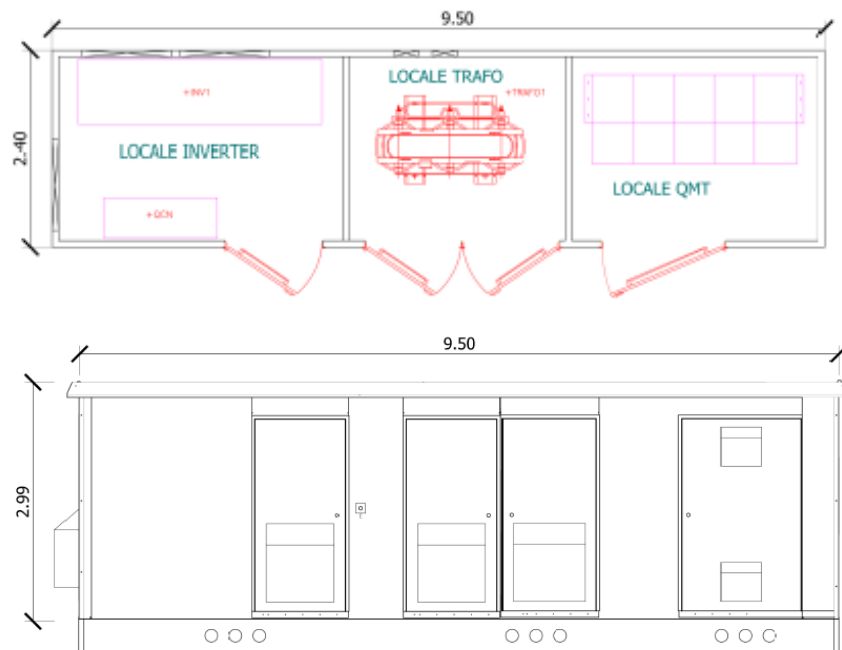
Pianta e prospetto cabina di conversione e trasformazione con un inverter
